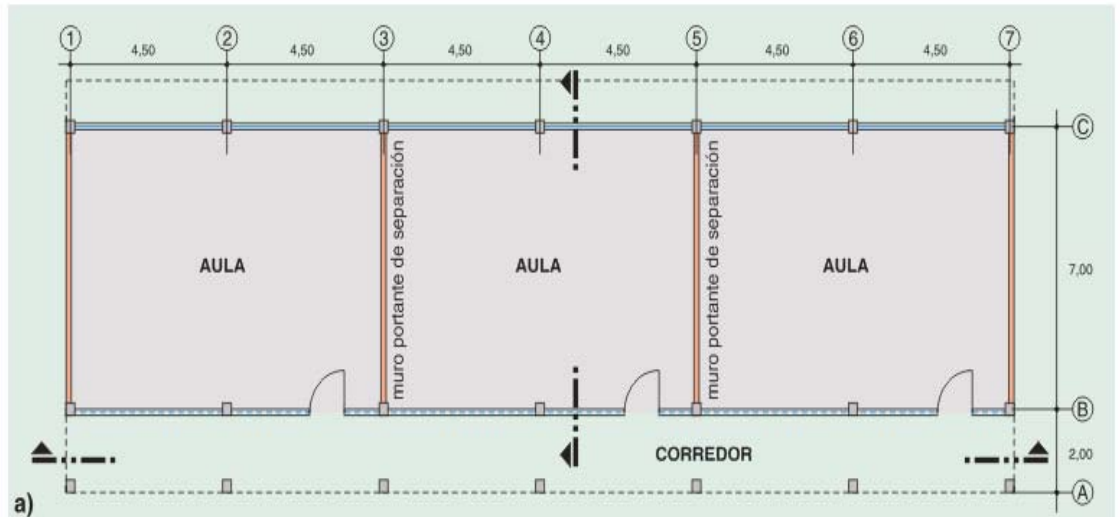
Planta típica de un local escolar con columnas cortas
